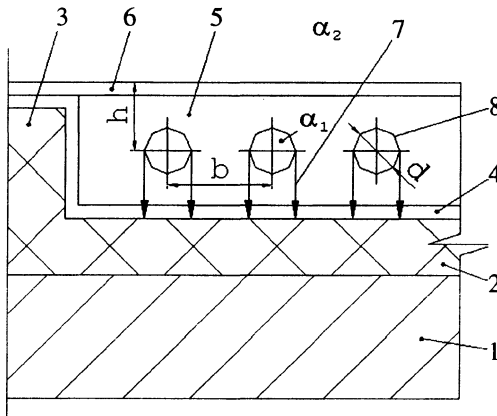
Схема конструкции напольного отопления: 1 – плита перекрытия; 2, 3, 4 – тепловая, тепловая крайняя и гидроизоляция; 5 – бетон; 6 – покрытие пола; 7 – якорная скоба; 8 – труба нагревательного элемента
